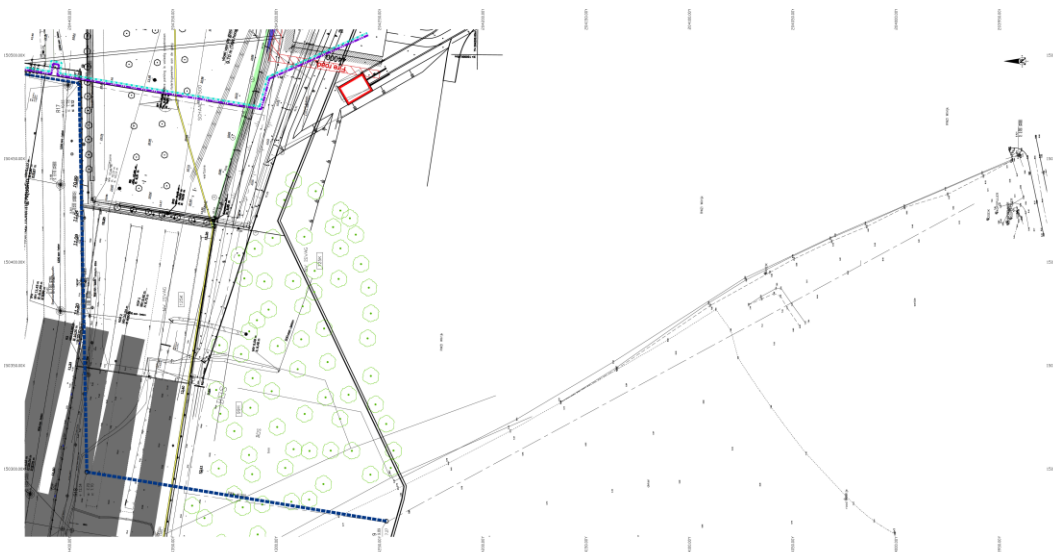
Plantekening van de riolering en het warmtenet in het plangebied (deel 2). Bron: opdrachtgever.
